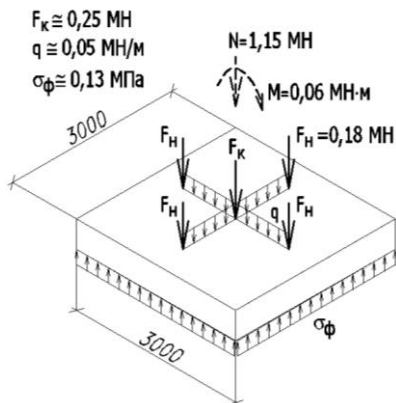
Расчетная схема системы «колонна с консолями – фундамент» на расчетные эксплуатационные нагрузки
